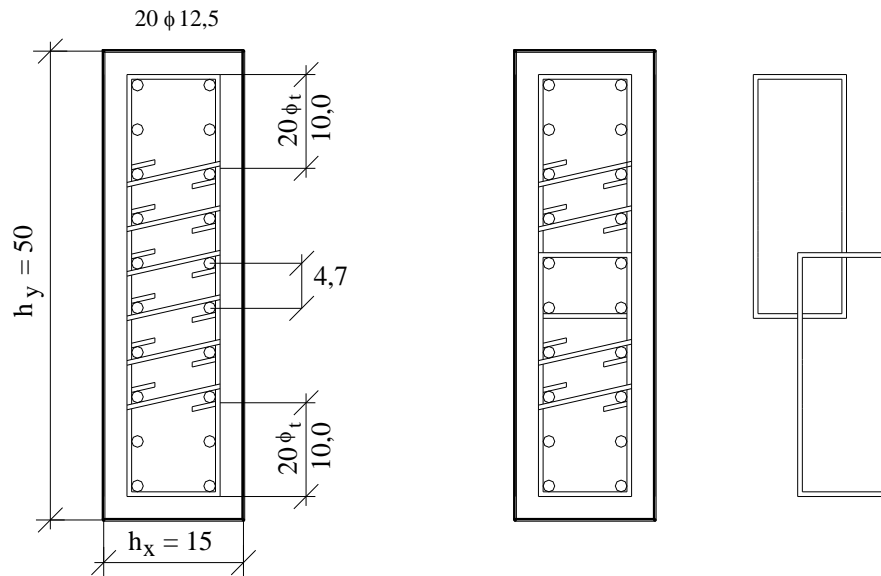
Detalhamento da armadura na seção transversal do pilar P8.
